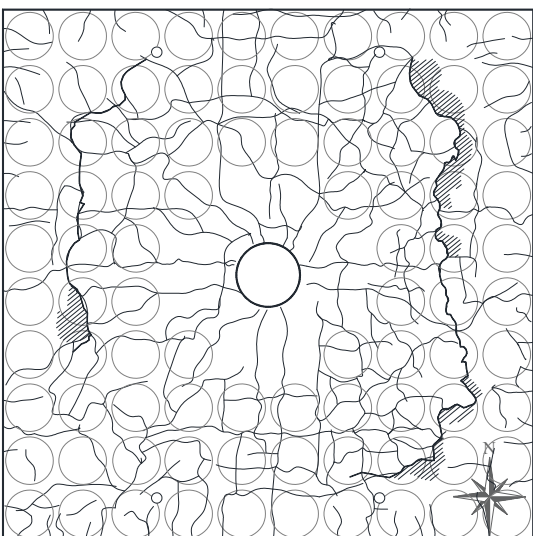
Mapa de fissuração da laje BD28-P2
